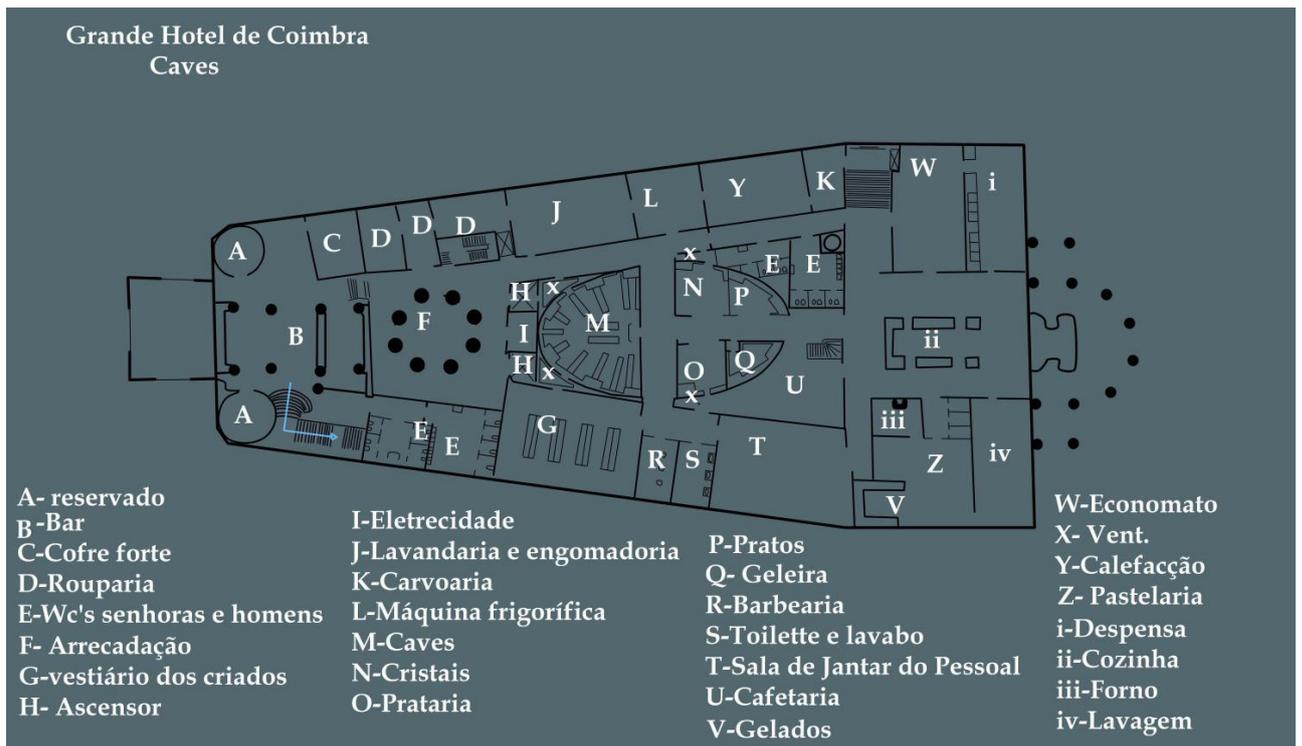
Planta Grande Hotel de Coimbra: Caves. Realizada pela Autora a partir da planta original.
